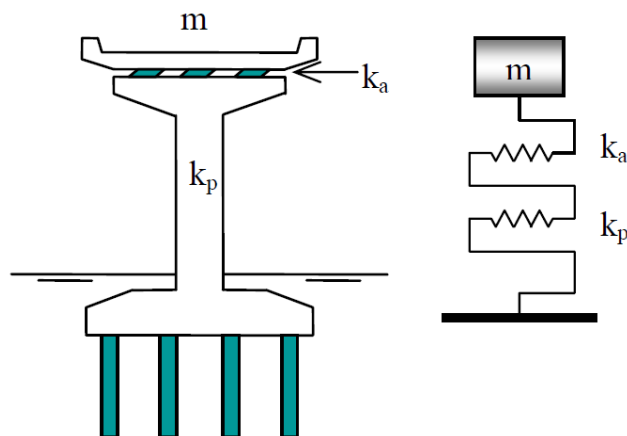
Esquema de la Rigidez de un Pilar (Landa, 2006)
